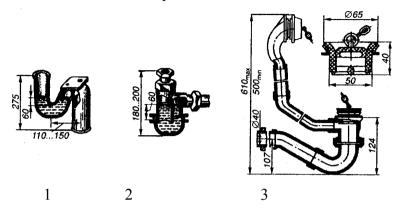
Сифоны: I — двуоборотный; 2 — бутылочный; 3 — напольный
